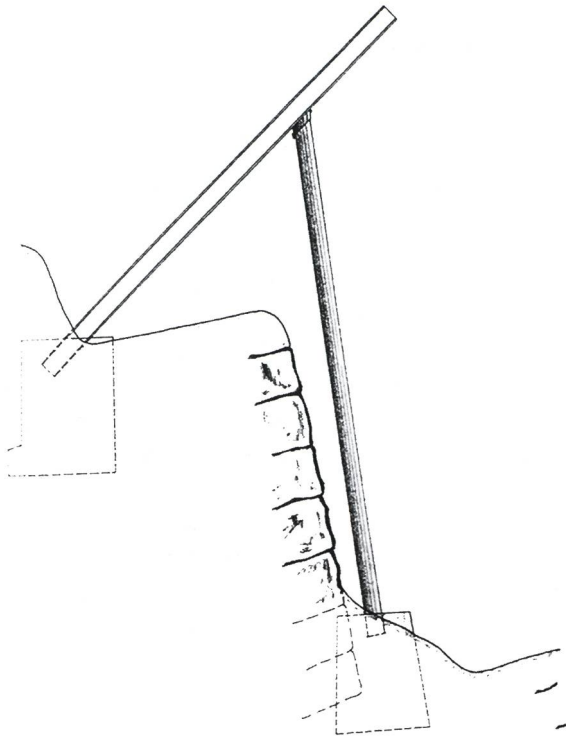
Skizze einer Schneebrücke aus Stahlträgern und Rundhölzern auf einer alten Mauerterrasse, Schnitt. (StAUR, R-272/1008 (6))
